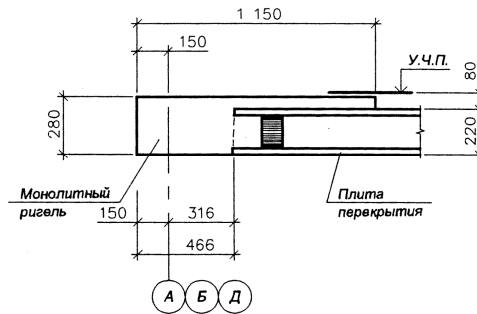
Стык плит перекрытия с ригелем (размеры условные):
